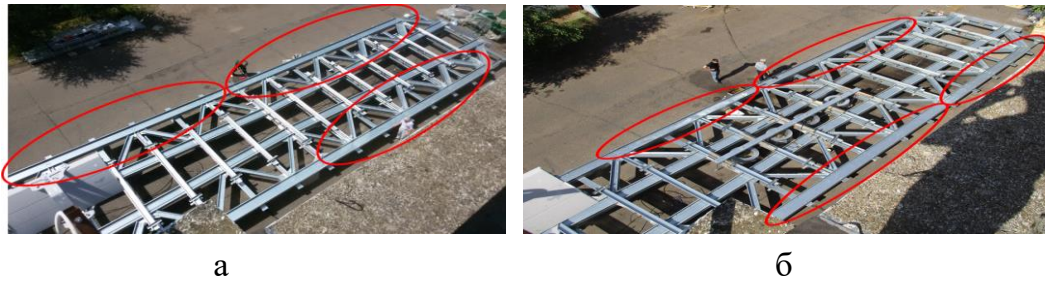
Фермы из ТХП: а – исходные фермы, нижний пояс из двух элементов; б – модернизированные фермы, нижний пояс из трех элементов
